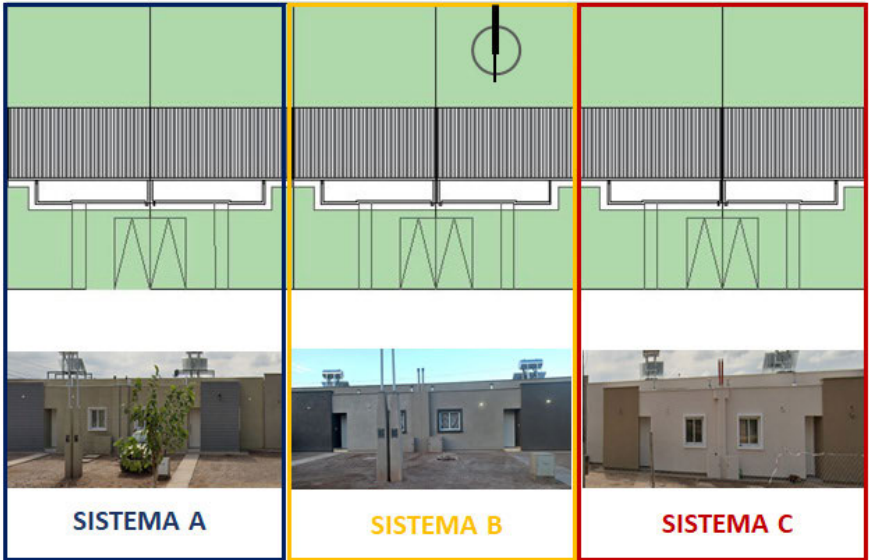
Planimetría y fachadas de las viviendas en estudio, Guaymallén, Mendoza (fuente: elaboración propia, 2023).
